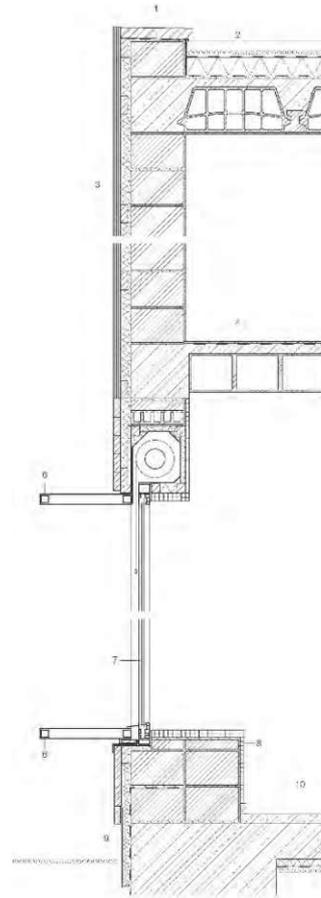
Fassadenschnitt "Wohnhaus in Bullas" [1]
